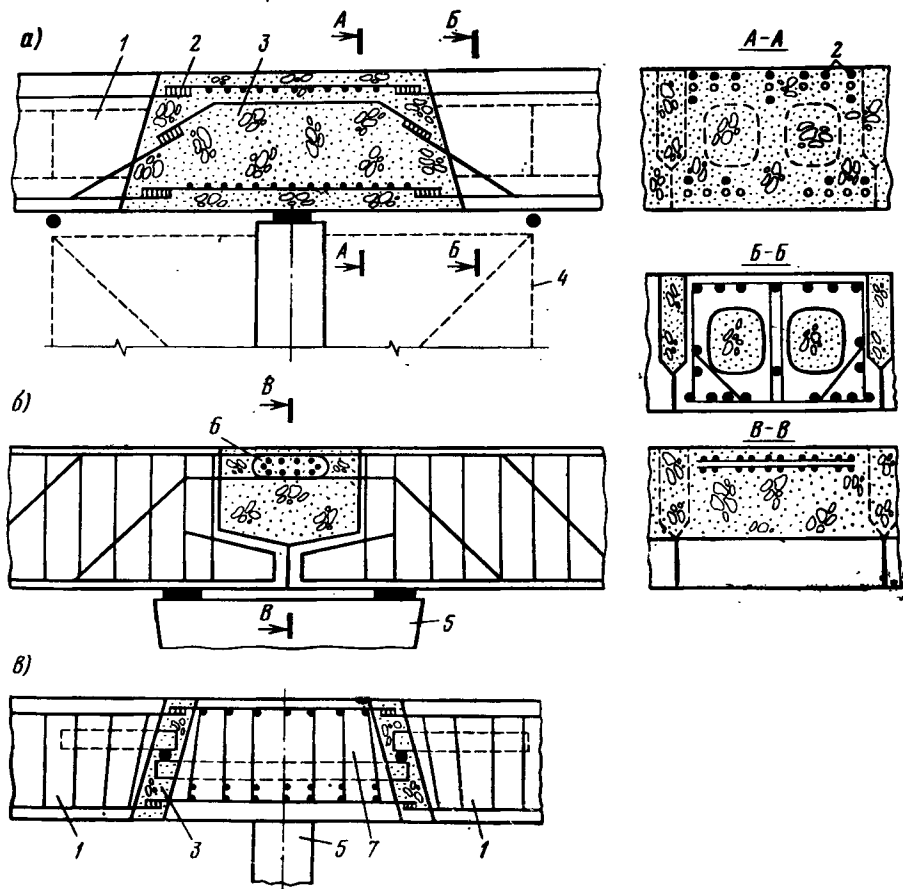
Конструкция надопорных стыков при образовании неразрезных и рамных плитных пролетных строений с ненапрягаемой арматурой:
